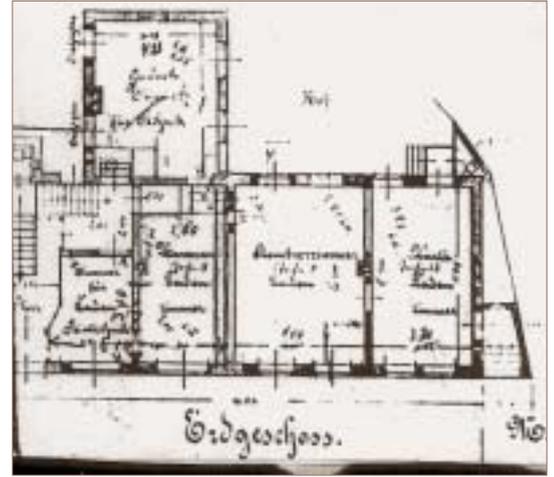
Grundriß des Hauses im Erdgeschoß.
